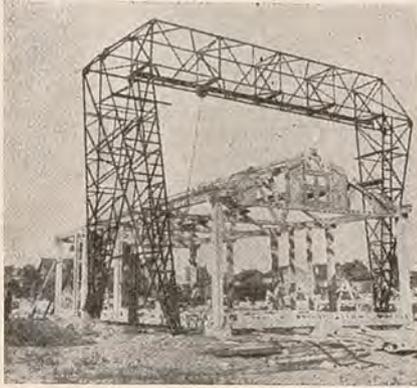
Gru a cavalletto in traliccio leggerissimo per montaggio di strutture prefabbricate in cemento armato.
